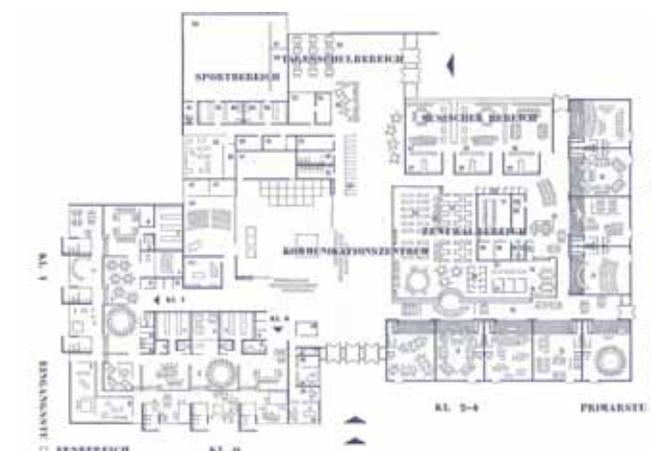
‚Modellgrundriss einer Primarschule‘ 1978
